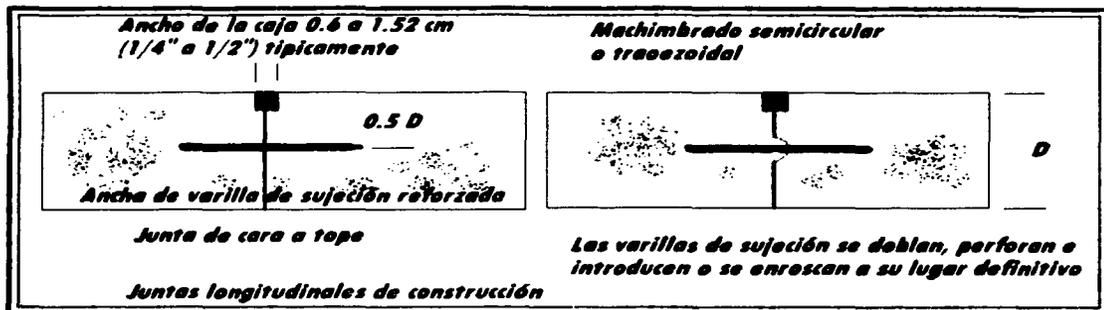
Juntas longitudinales de construcción con machimbrado.
